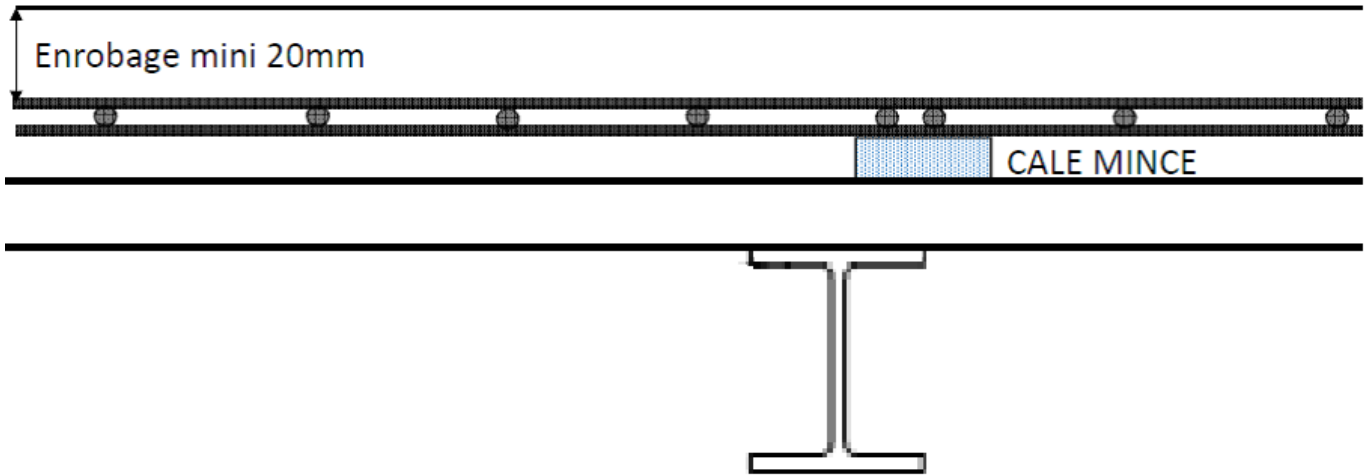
Superposition des treillis soudés en cas de double nappe avec treillis soudé du dessus positionné à l'envers
